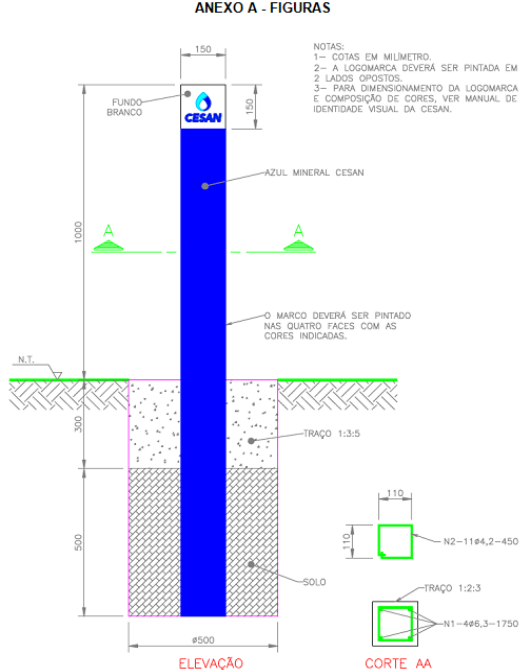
MARCO DELIMITADOR DE FAIXA TIPO HASTE DE CONCRETO
